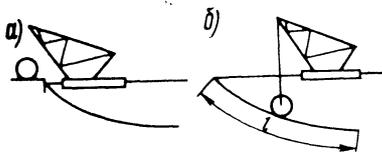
Схема работ по укладке карты покрытия с помощью барабана и плавучего крана:
